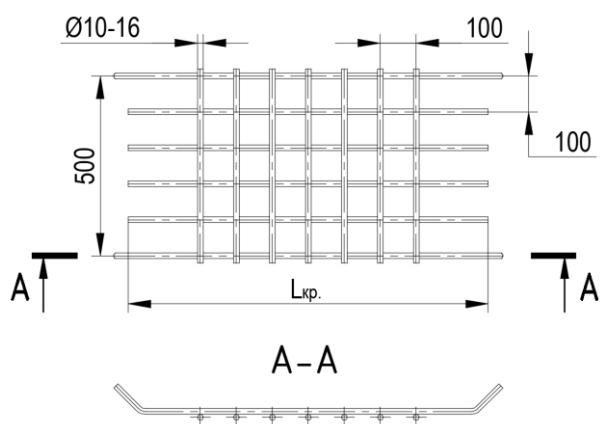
Затяжка сварная рамной крепи
